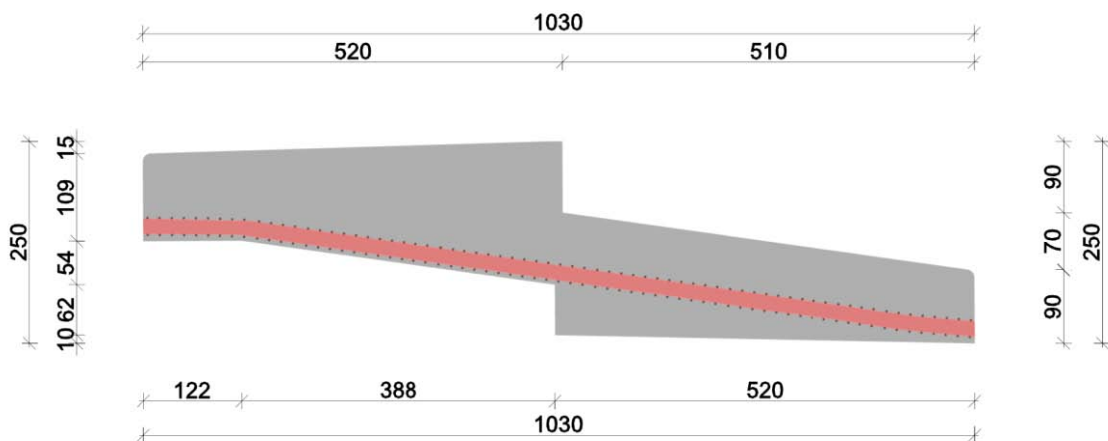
Ansicht - Betonfläche eines Rampenträgers
